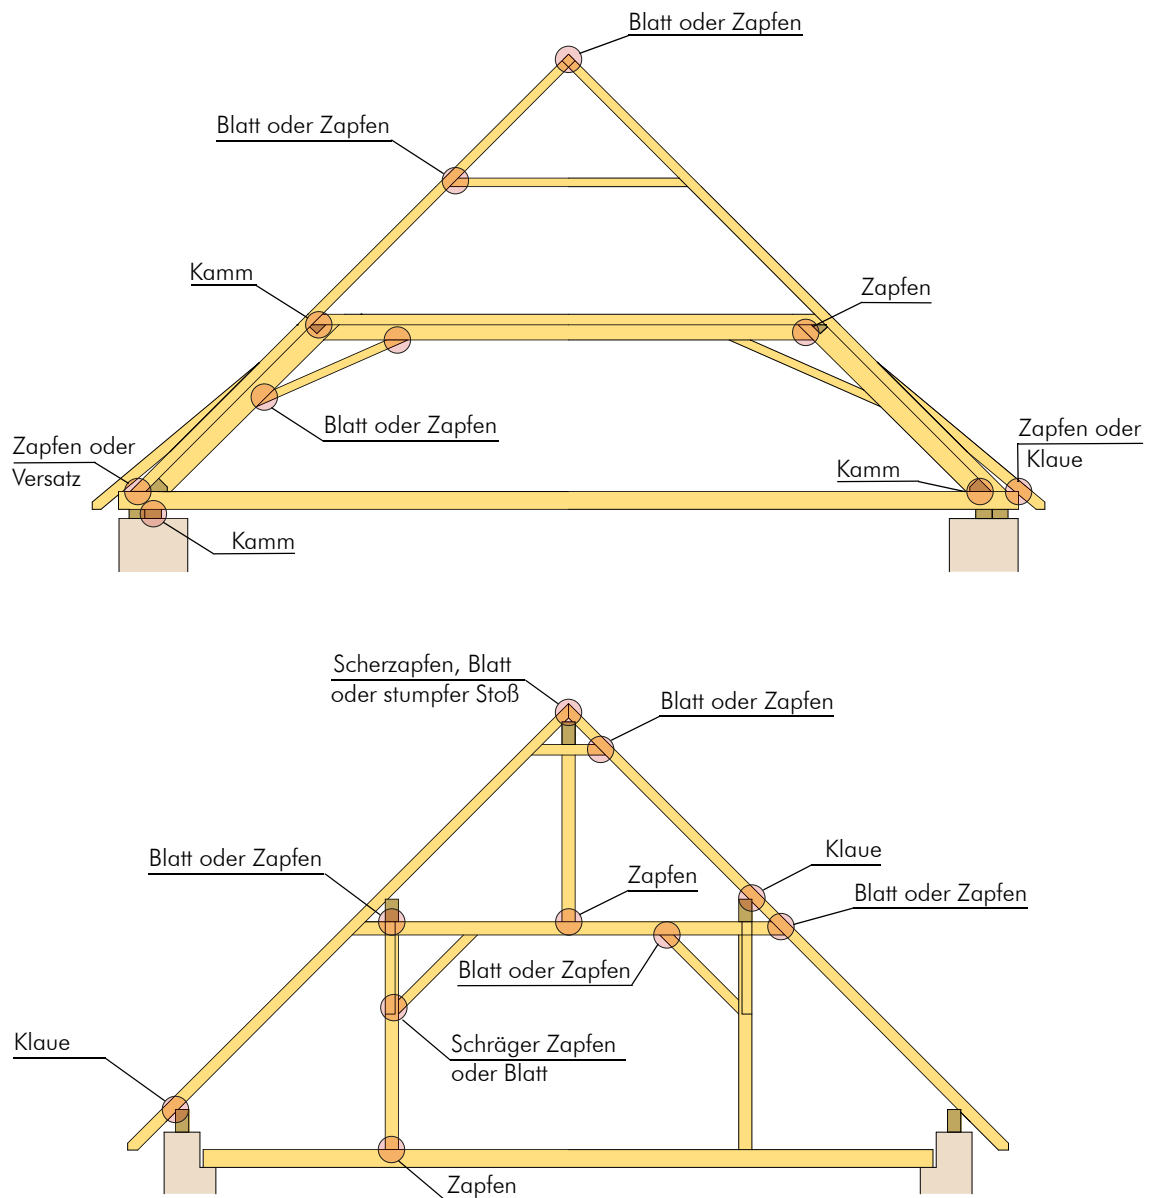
Mögliche Lage verschiedener Verbindungsarten in Dachtragwerken, oben: Kehlbalkendach mit liegendem Stuhl und Hahnenbalken, unten: Pfettendach mit mehrfach stehendem Stuhl
